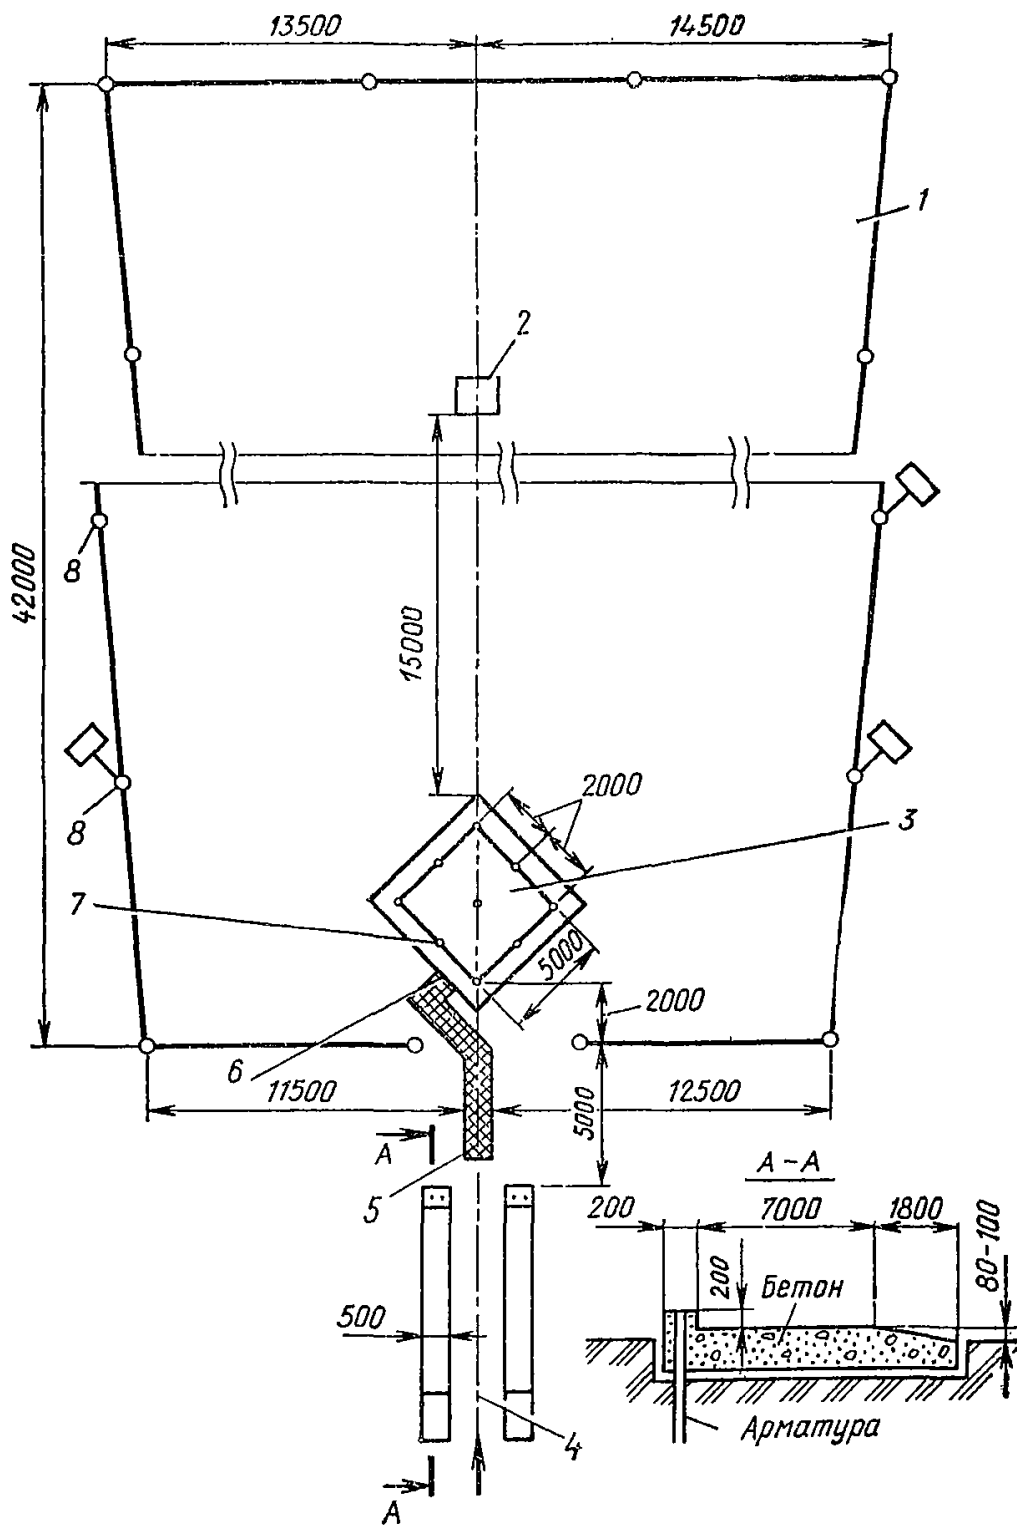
Площадка для проверки и ремонта войсковых дозиметрических приборов:
